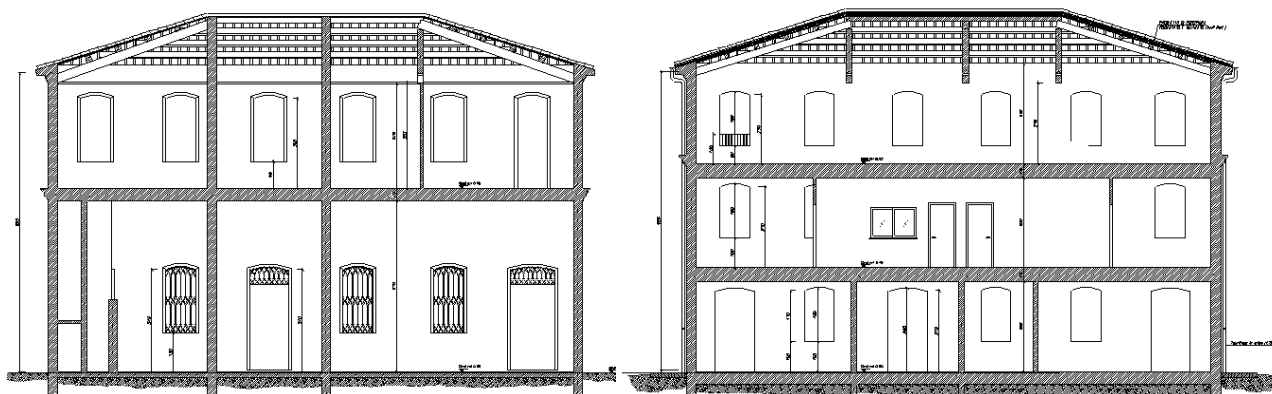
Confronto sezioni stato di fatto e di progetto.
